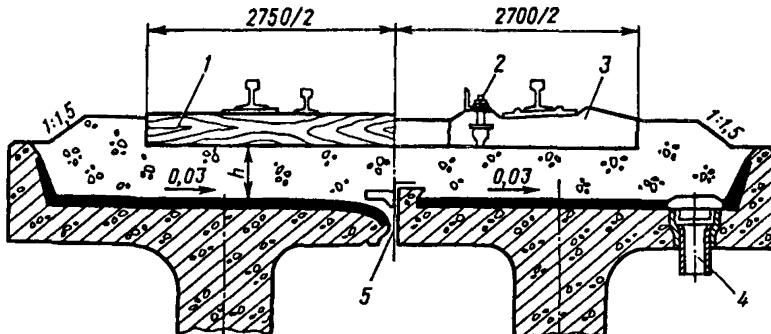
Мостовое полотно с ездой на балласте на деревянных (слева) и железобетонных (справа) шпалах:
